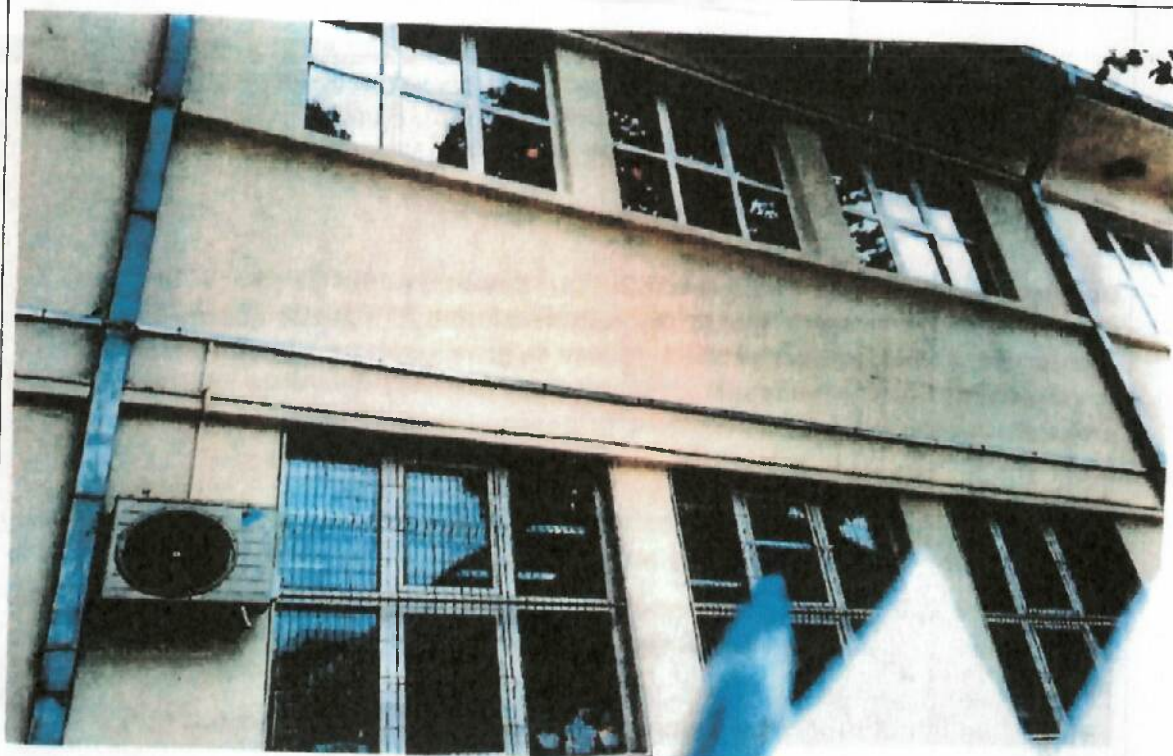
Situație existentă – fisura orizontală la nivelul planșeului peste parter la corp C1-tronson B
